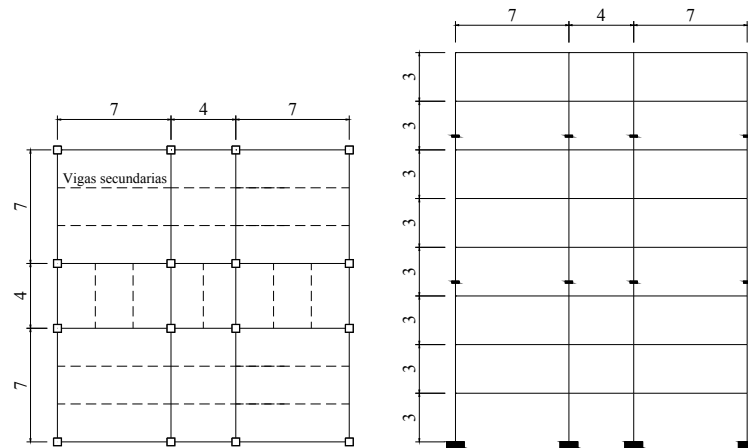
Vista en planta y elevación de la estructura de ocho niveles (dimensiones en metros)
